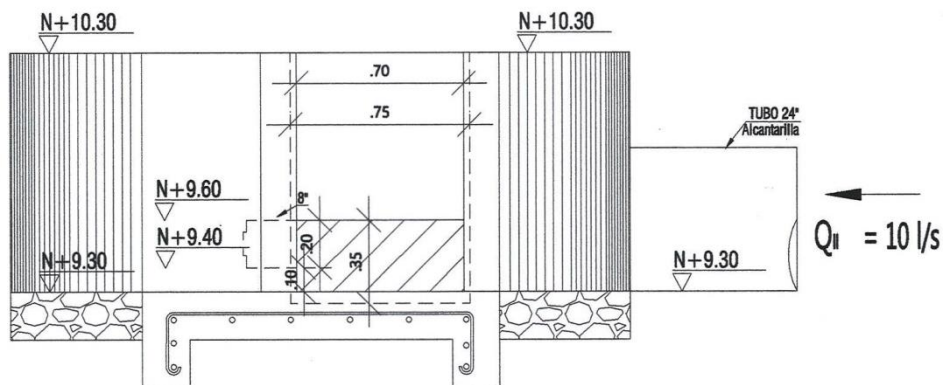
Detalles de la obra de captación, vista en corte transversal.
